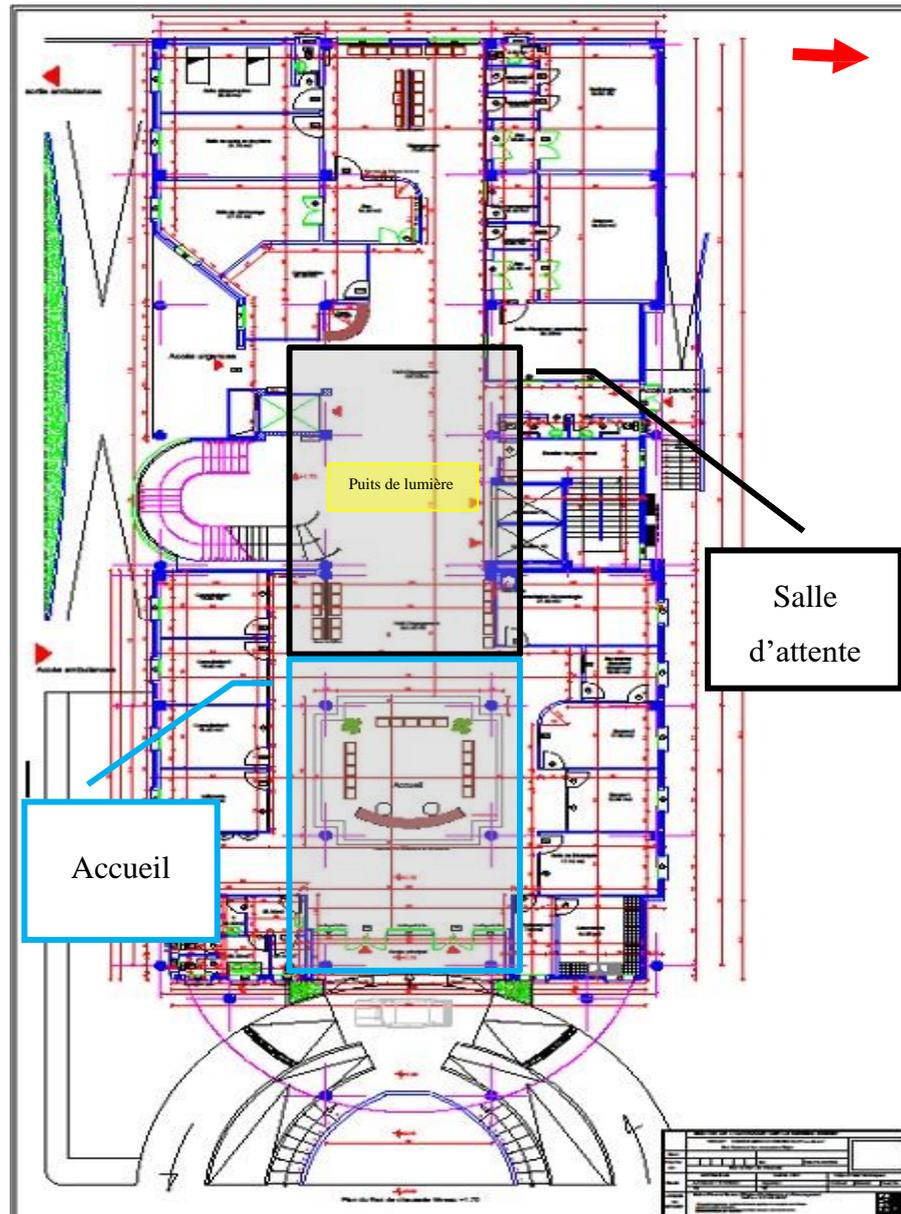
10: plan de rez-de-chaussée de la clinique privée le rameau d'olivier
